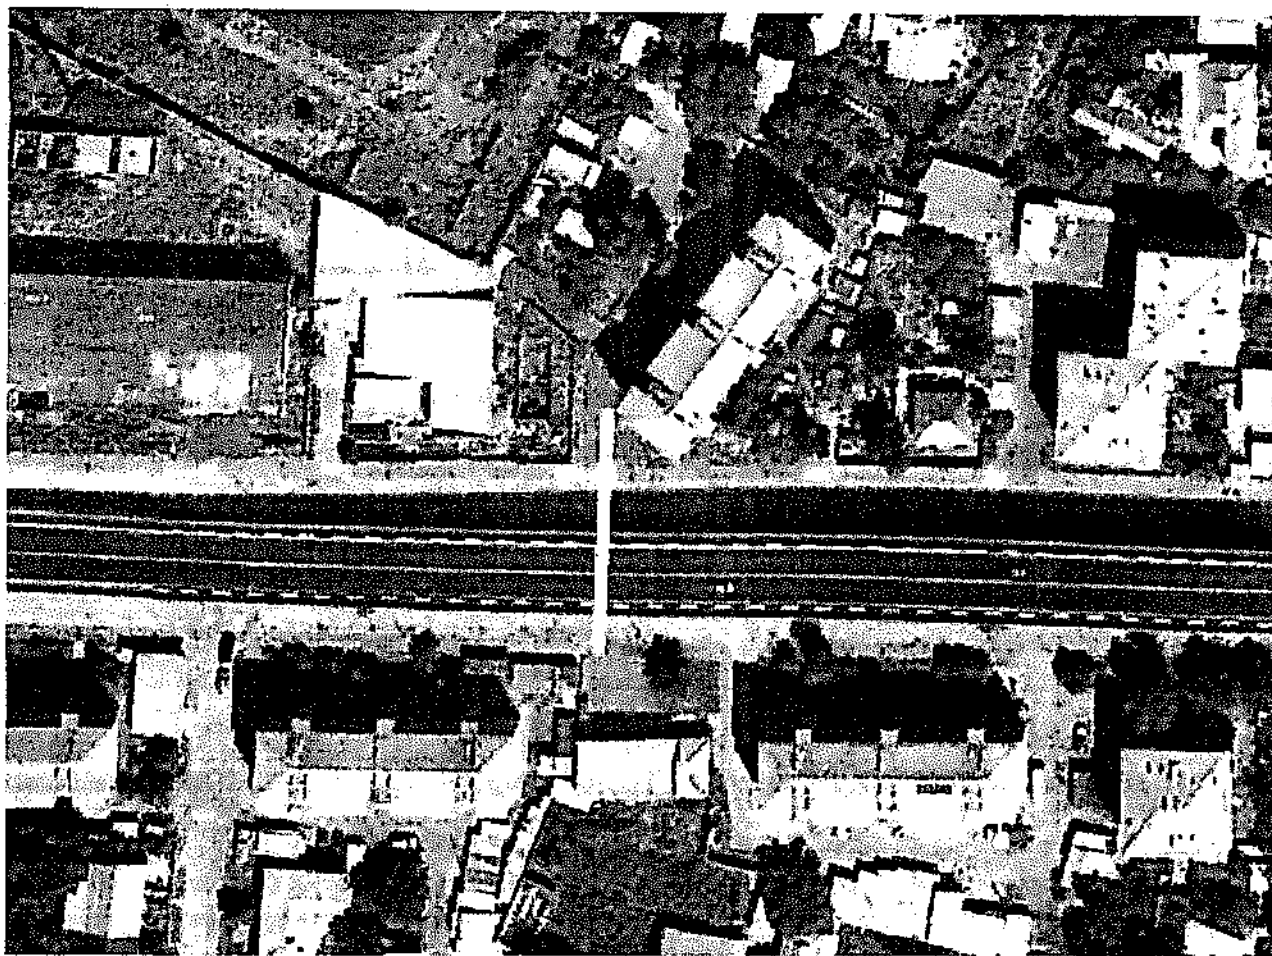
Ситуационный план-схема подземного газопровода низкого давления города Артик от улицы Абовяна до перекрестка улицы Туманяна – Участок №2.
